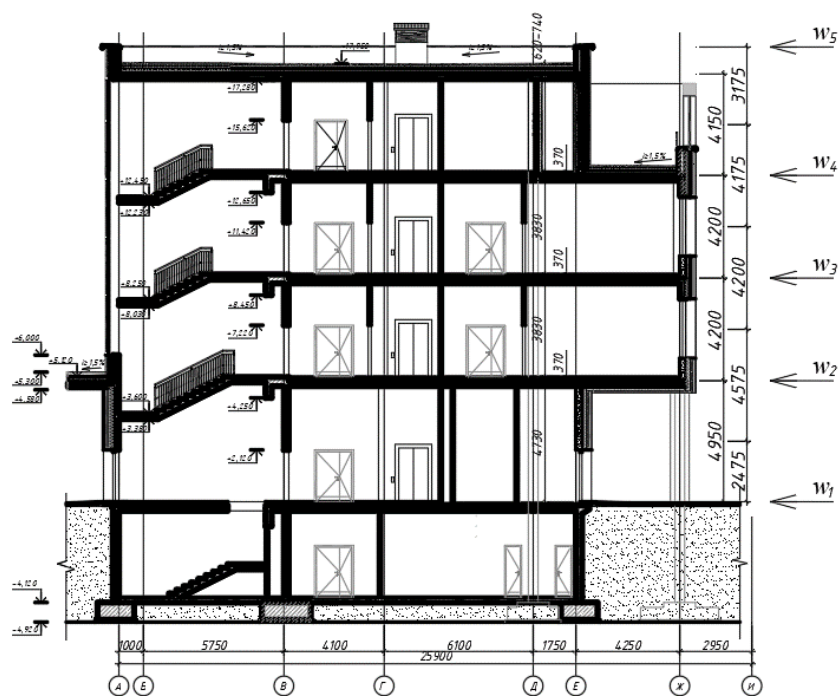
Размеры грузовых полос для приведения распределенной ветровой нагрузки к погонной в уровне плит перекрытий
